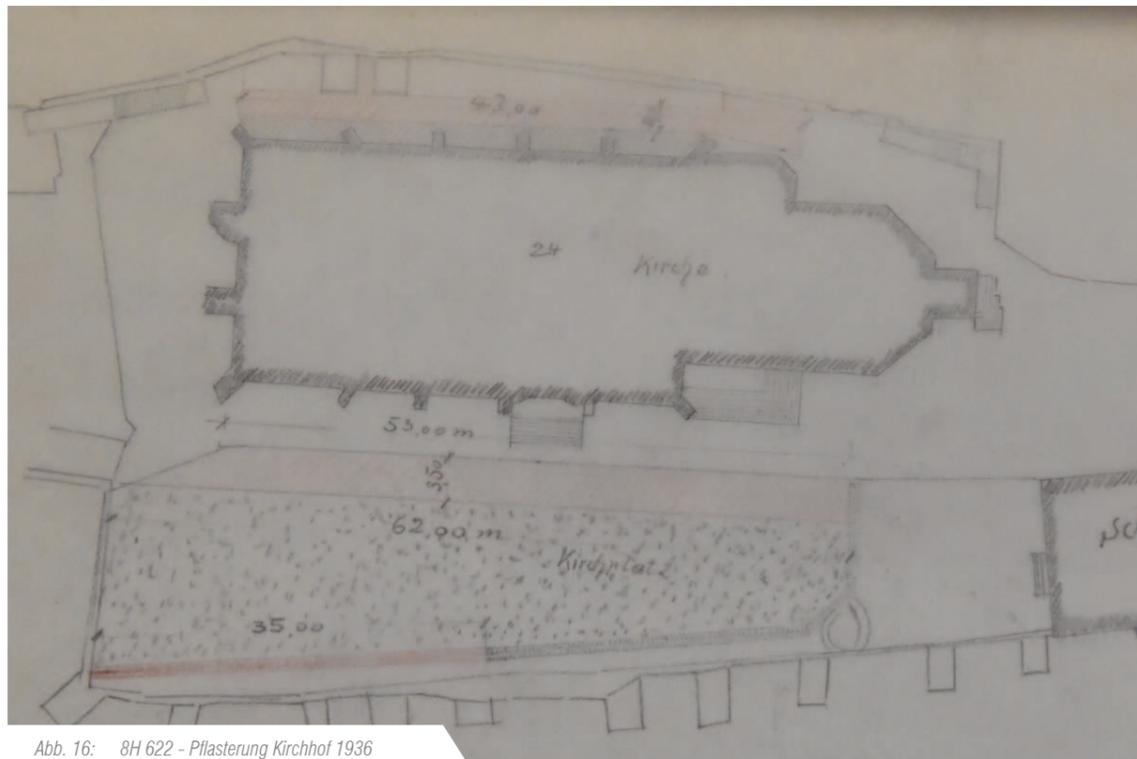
8H 622 - Pflasterung Kirchhof 1936
